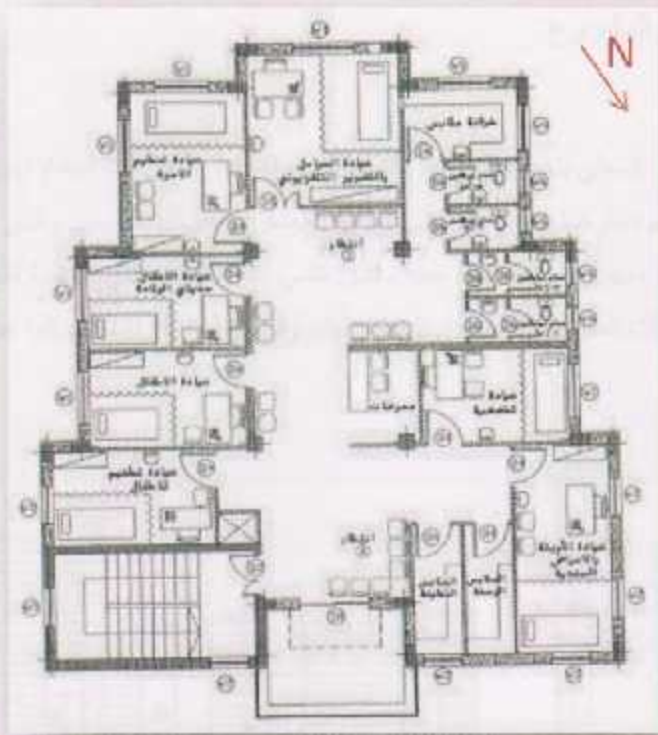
المسقط الأفقي للطابق الأرضي
